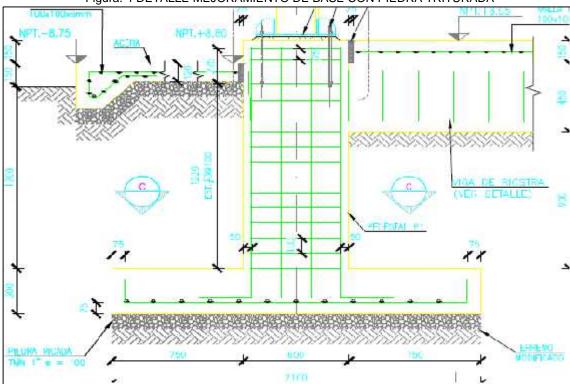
DETALLE MEJORAMIENTO DE BASE CON PIEDRA TRITURADA
